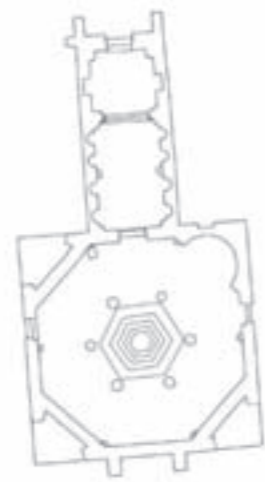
Aquileia, Baptisterium und Chiesa dei Pagani, Grundriss Erdgeschoss, Tachymeteraufmaß HS Augsburg 2009.
